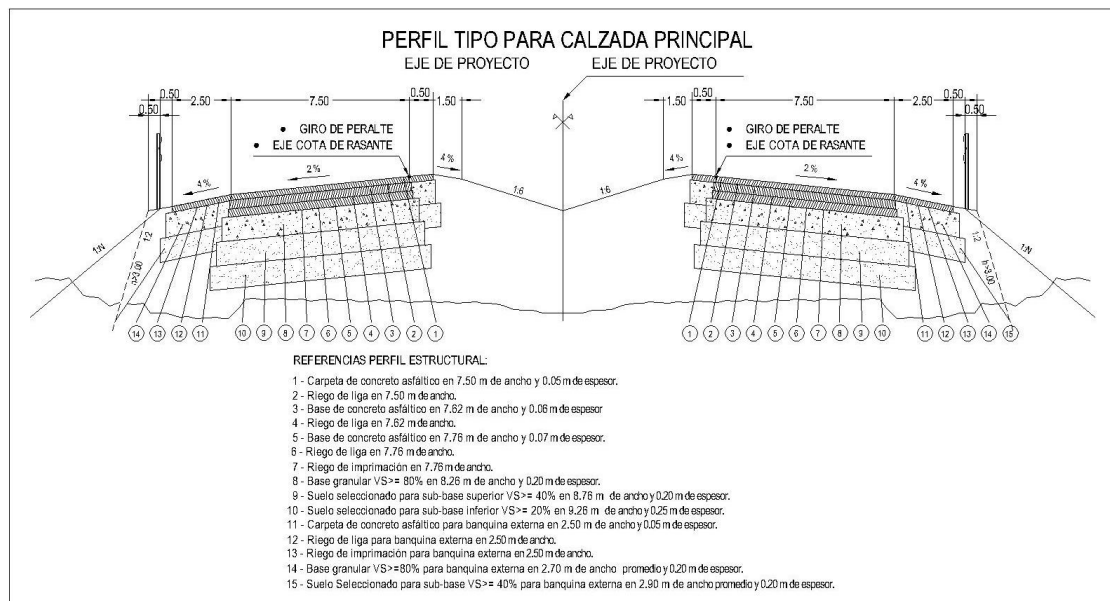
Perfil Tipo de estructura de pavimento para Calzada Principal
